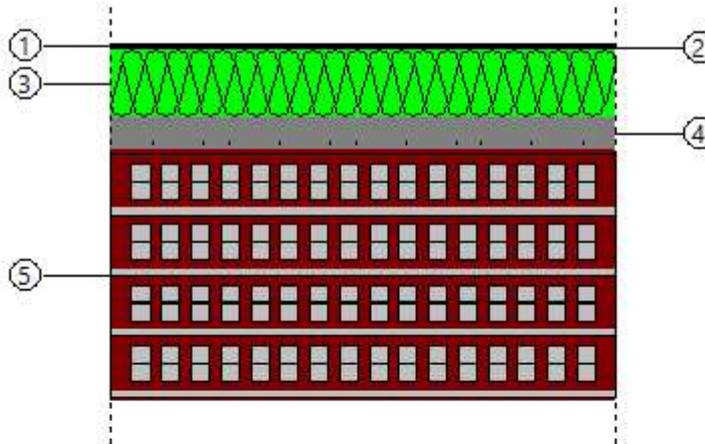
Situación de la Azotea de la Planta Cubierta en la vivienda. CYPETHERM HE Plus
